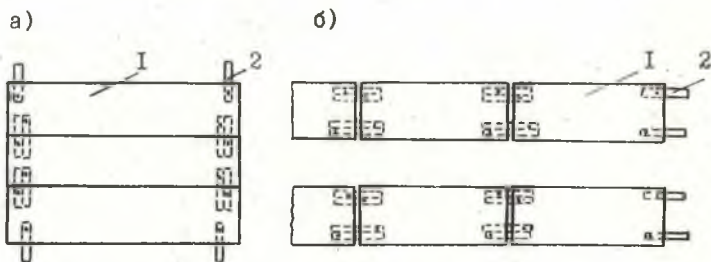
Универсальное покрытие: а - сборка покрытия в колесопроводы; б - покрытие в виде сплошного настила; 1 - щиты; 2 - поворотные элементы
